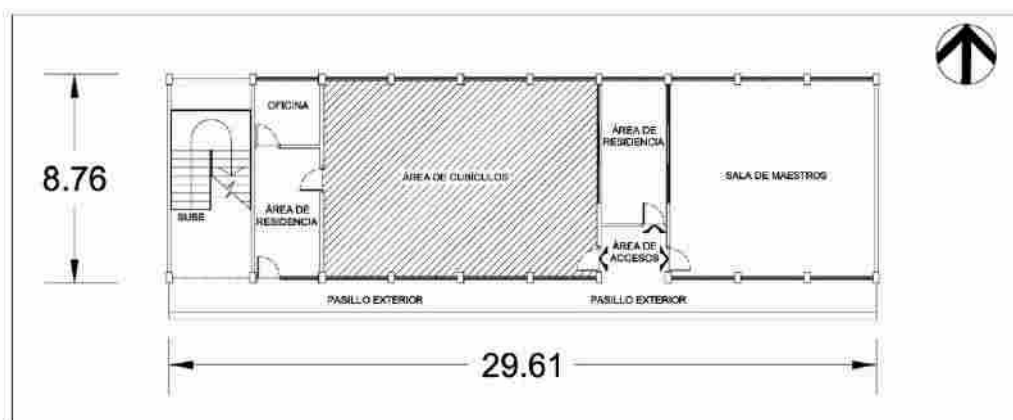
Croquis de levantamiento planta baja Edificio T (elaboración propia).
